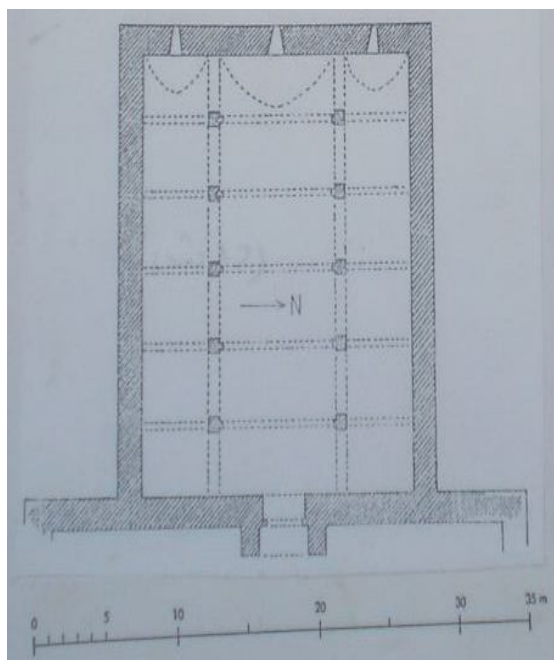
مسقط أفقي لخان ماه برى خاتون
